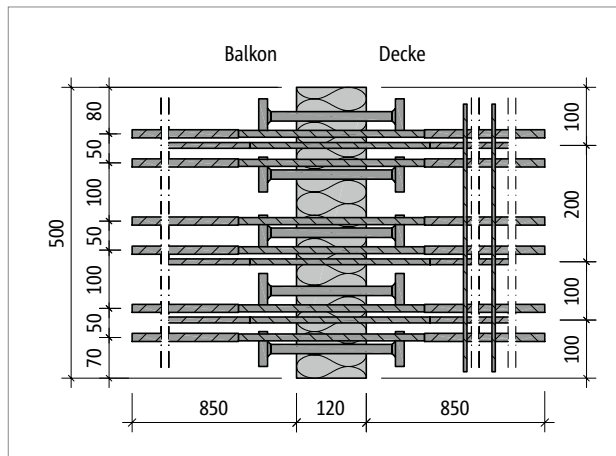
Schöck Isokorb® XT Typ KP-M11: Produktgrundriss
